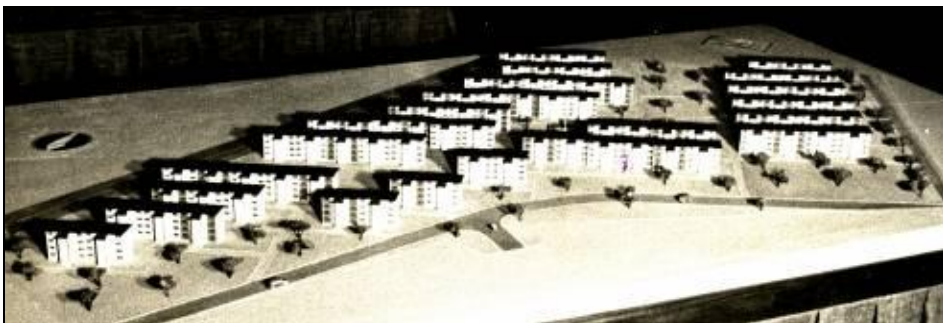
Maqueta proyecto Ciudad Tablitas en Exposición Plan Nacional de la Vivienda
